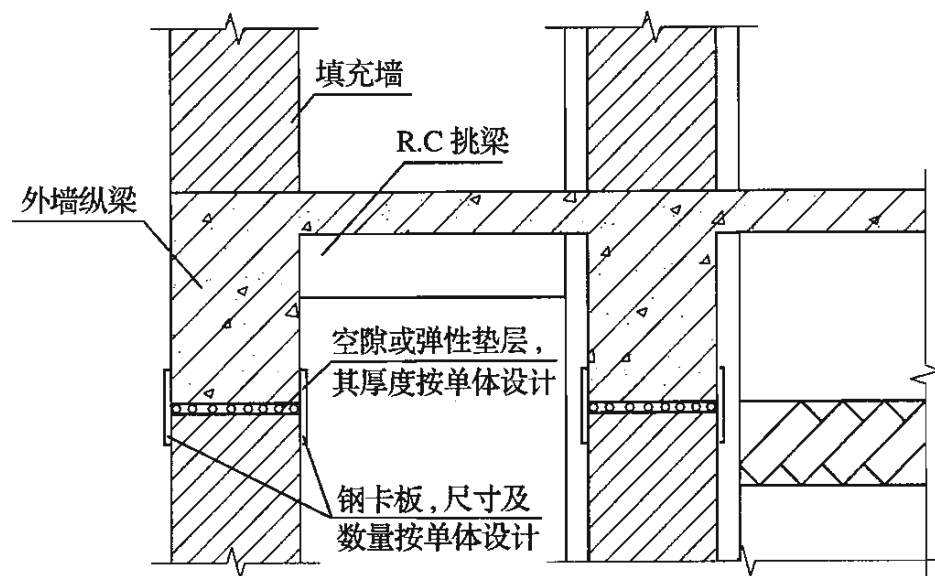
悬挑外廊填充墙脱开示意图
